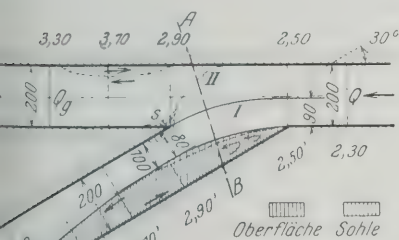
Lageplan, M 1 : 25, mit Trennlinien und Wasserwalzen
